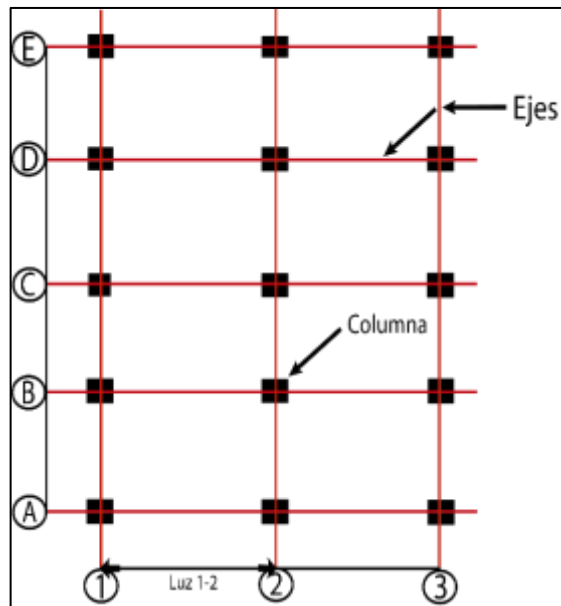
Plano de columnas; Fuente: [Grupo investigador]
